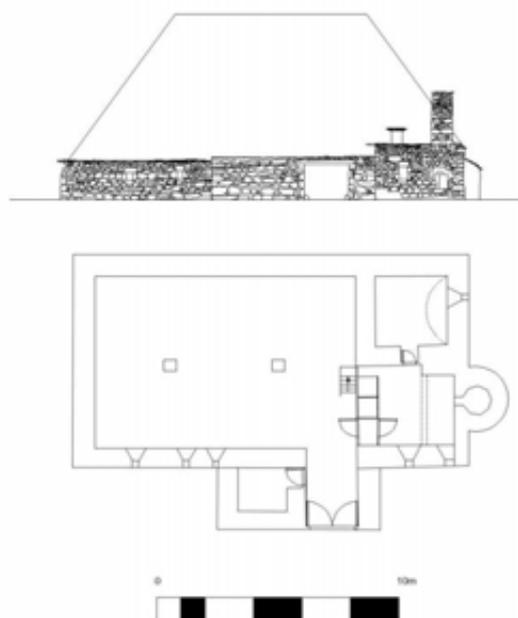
Plan et façade types de la maison-mixte, d'après les relevés de la ferme Philip, Sainte-Eulalie (07)
